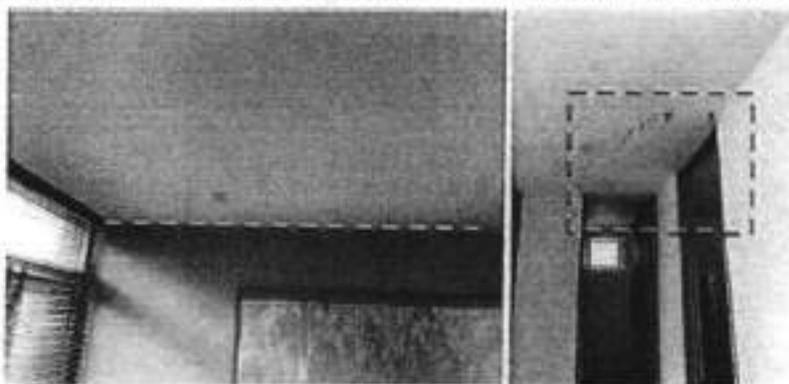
y 26. Fisuras en recubrimiento cara interna de placa de cubierta del apartamento 101 predio P1
